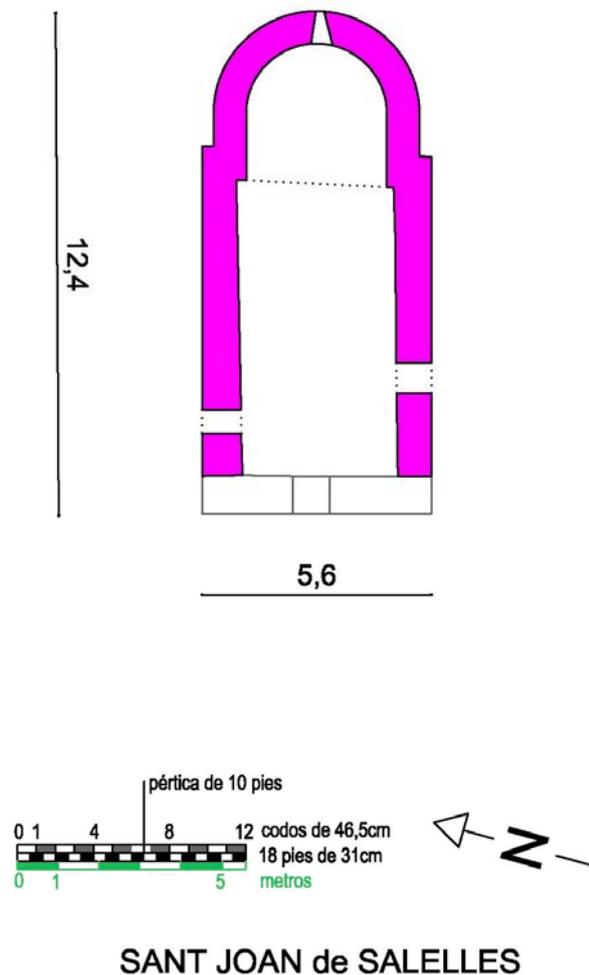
Planta crono-cromática de St. Joan. Elaborada por autora.
